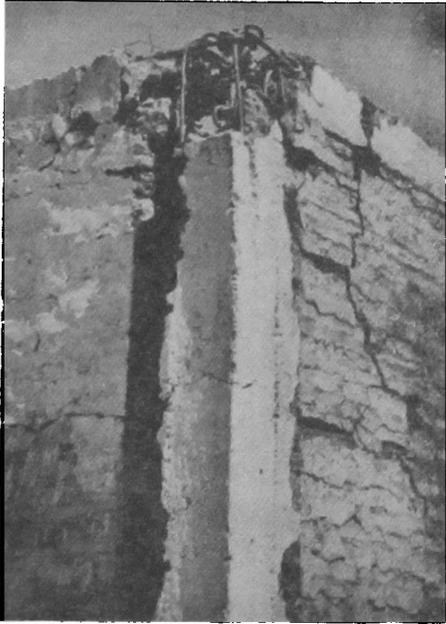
Rotura de la conexión en esquina de cadenas y pilar. Casa de Las Melosas.
